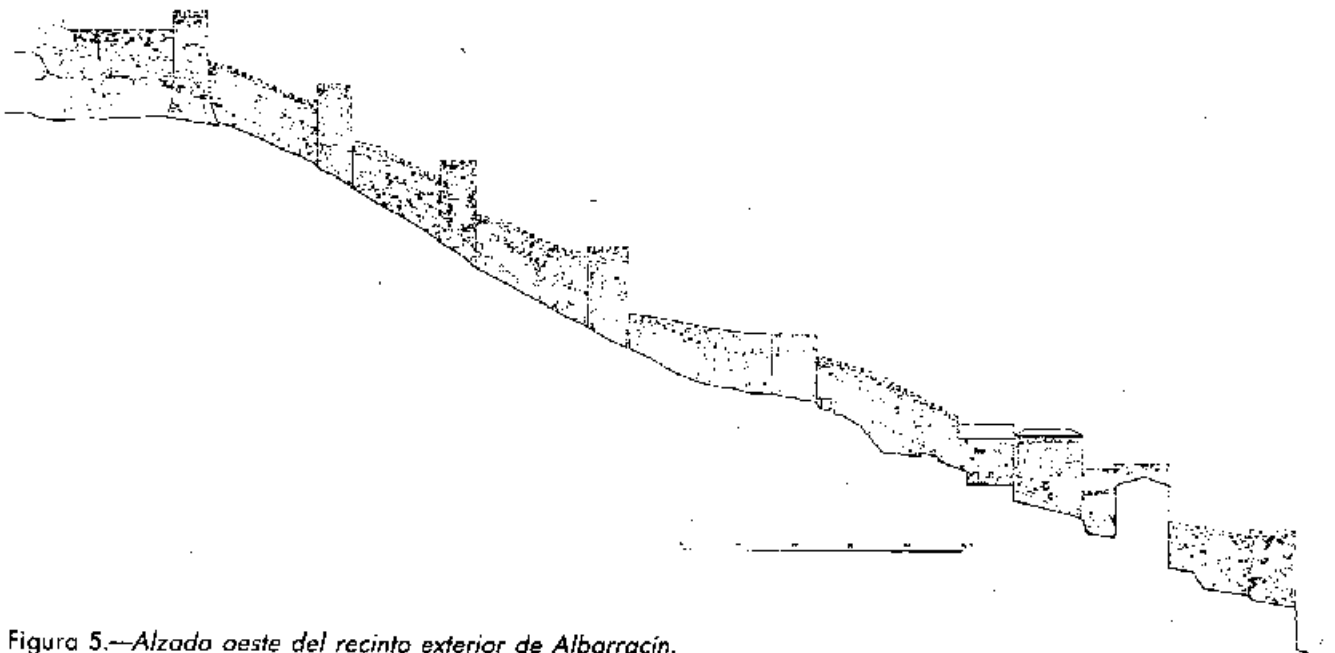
Alzado oeste del recinto exterior de Albarracín.
